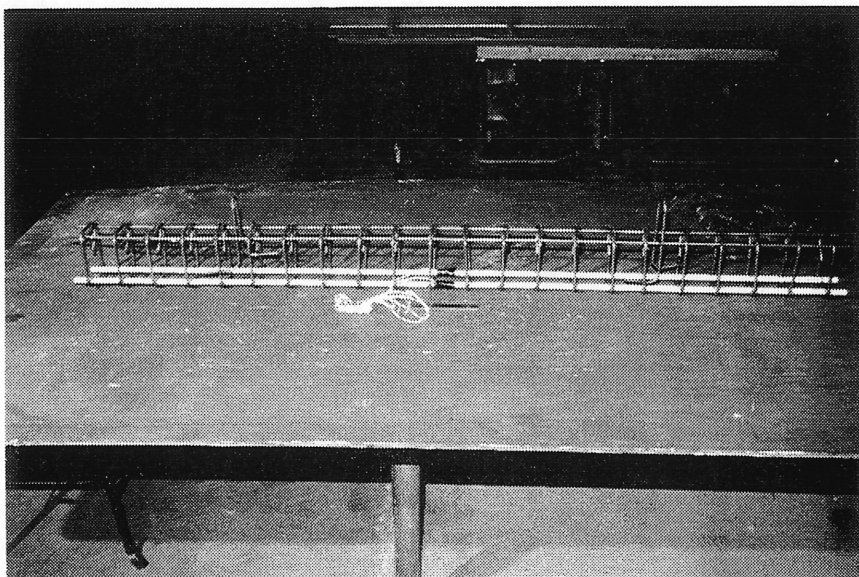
Vue de l'armature d'une poutre BC2 avant la coulée du béton
